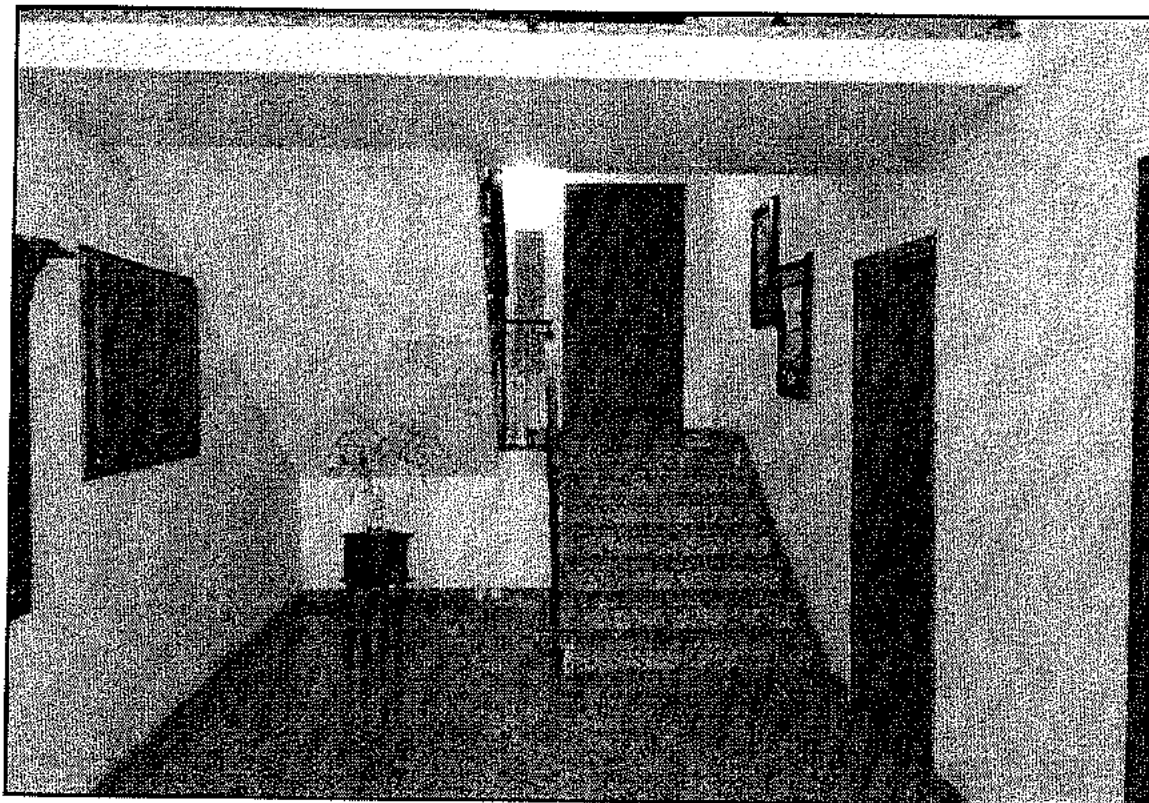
L'ingresso al fabbricato dal portone d'ingresso
